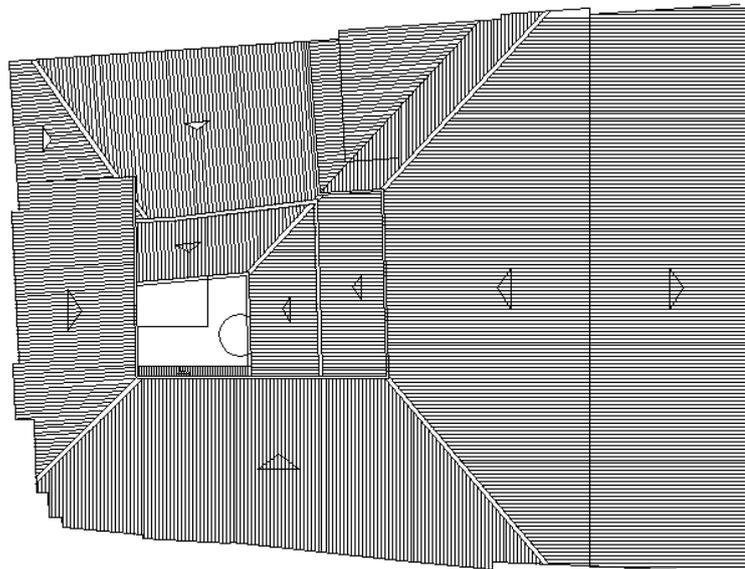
Ilustração de Planta de Cobertura e desenho do lote.
